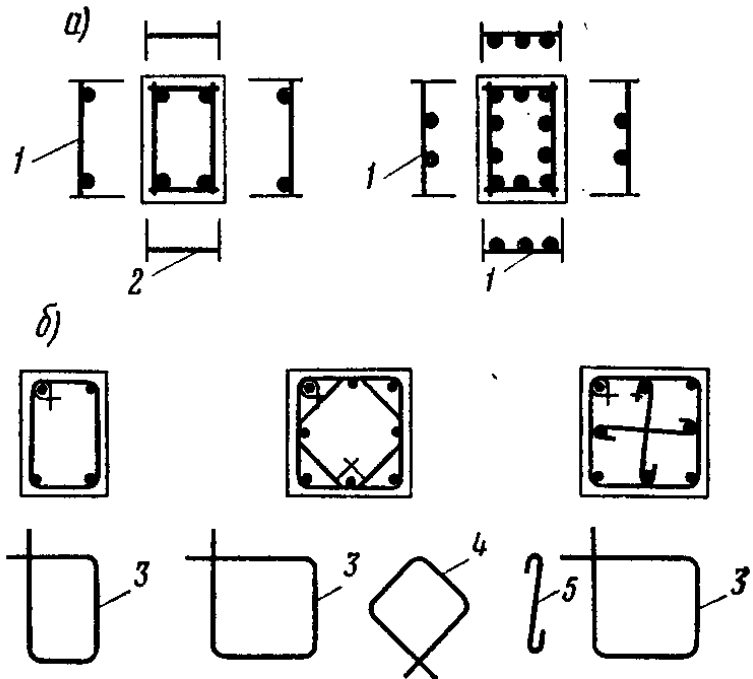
Армирование сжатых элементов со случайными эксцентриситетами
